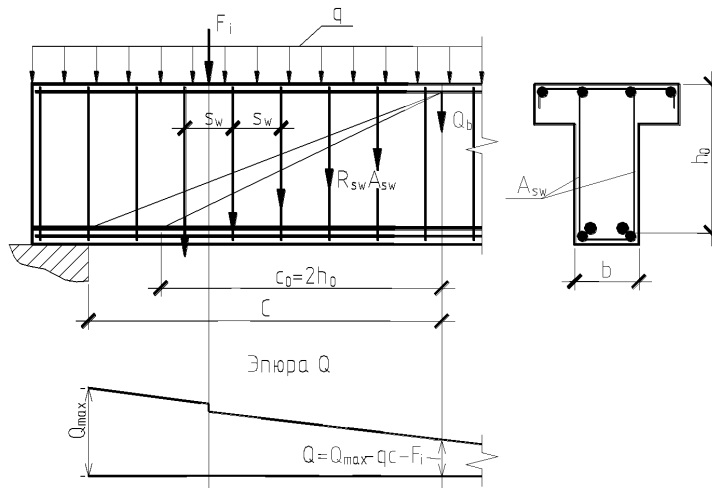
Схема усилий в наклонном сечении элемента, армированного хомутами, при расчете на действие поперечной силы
